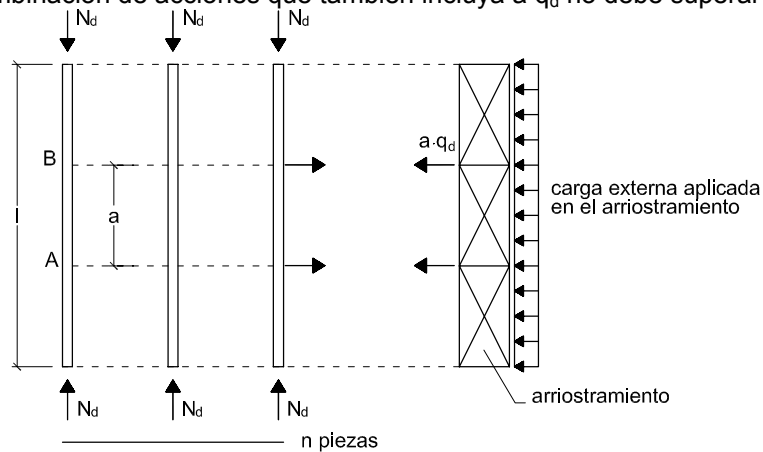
Sistema de vigas o cerchas que requieren restricciones laterales
